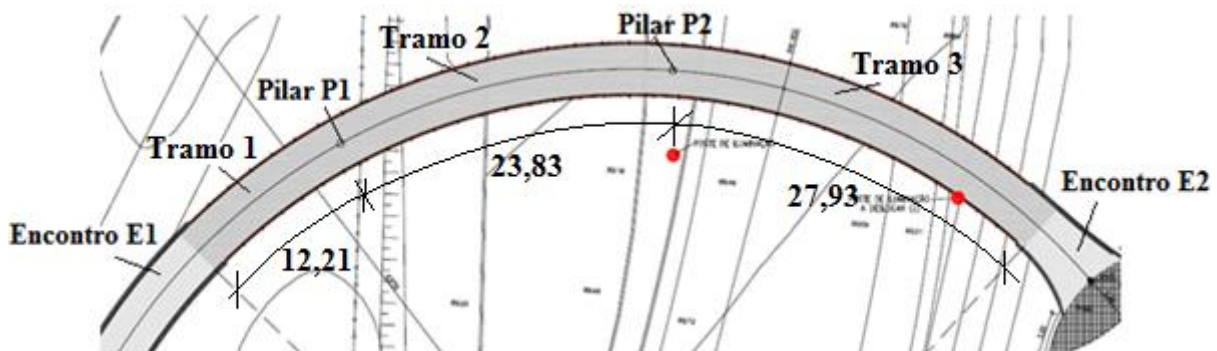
Traçado do tabuleiro da solução com viga caixão, em planta [24].
